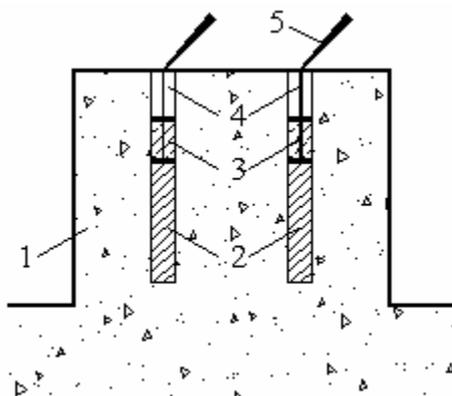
Схема размещения шпуровых зарядов при разрушении фундамента: 1 – фундаменты; 2 – забойка; 3 – электродетонатор; 4 – шпуры; 5 – заряд ВВ
